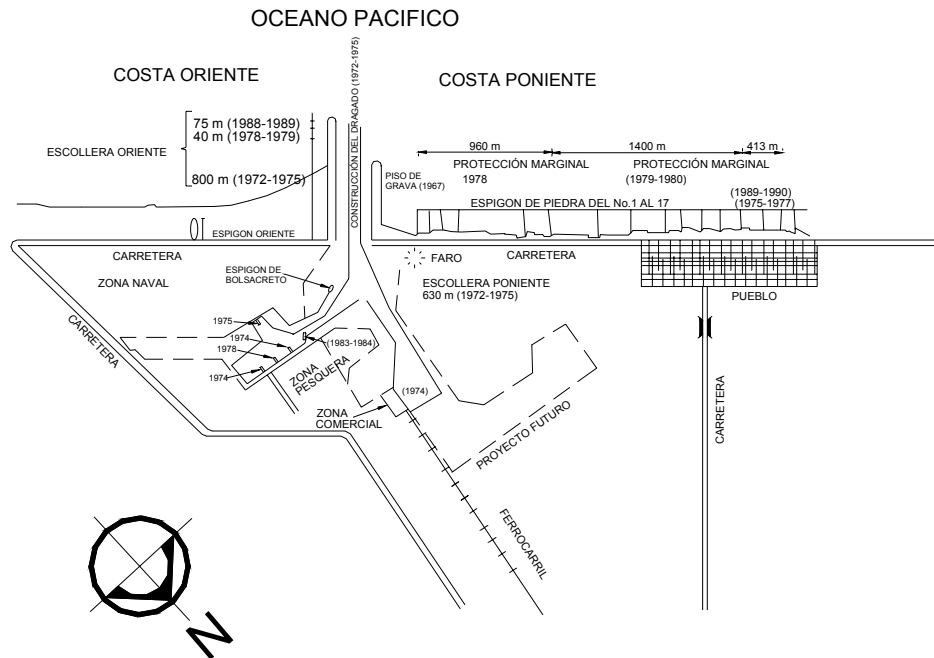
Arreglo general del puerto y etapas de construcción de las obras exteriores e interiores
